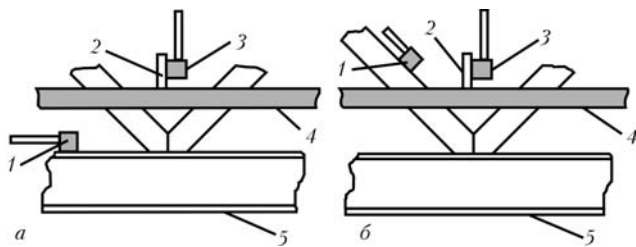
Расположение ПАЭ во время нагружения пролета 0-1 (а) и пролетов 1-2 и 2-3 (б): 1 – ПАЭ № 1; 2 – волновод; 3 – ПАЭ № 2; 4 – железобетонная плита проезжей части; 5 – нижний пояс фермы
